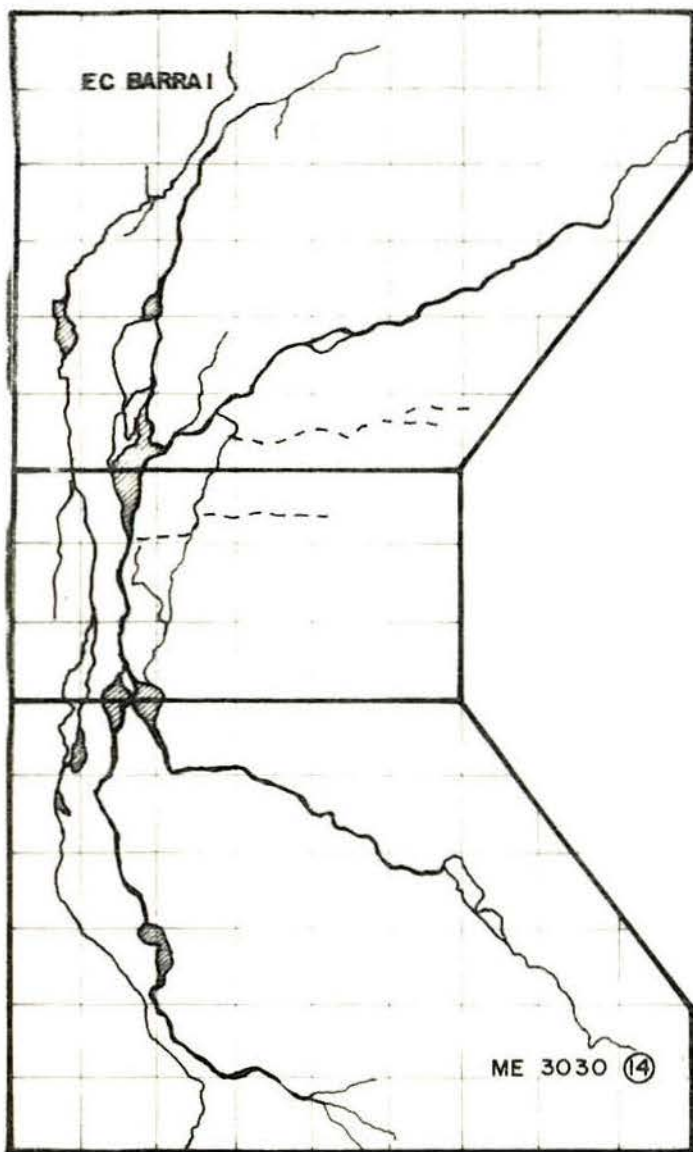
Fissuração dos CP ME3030
